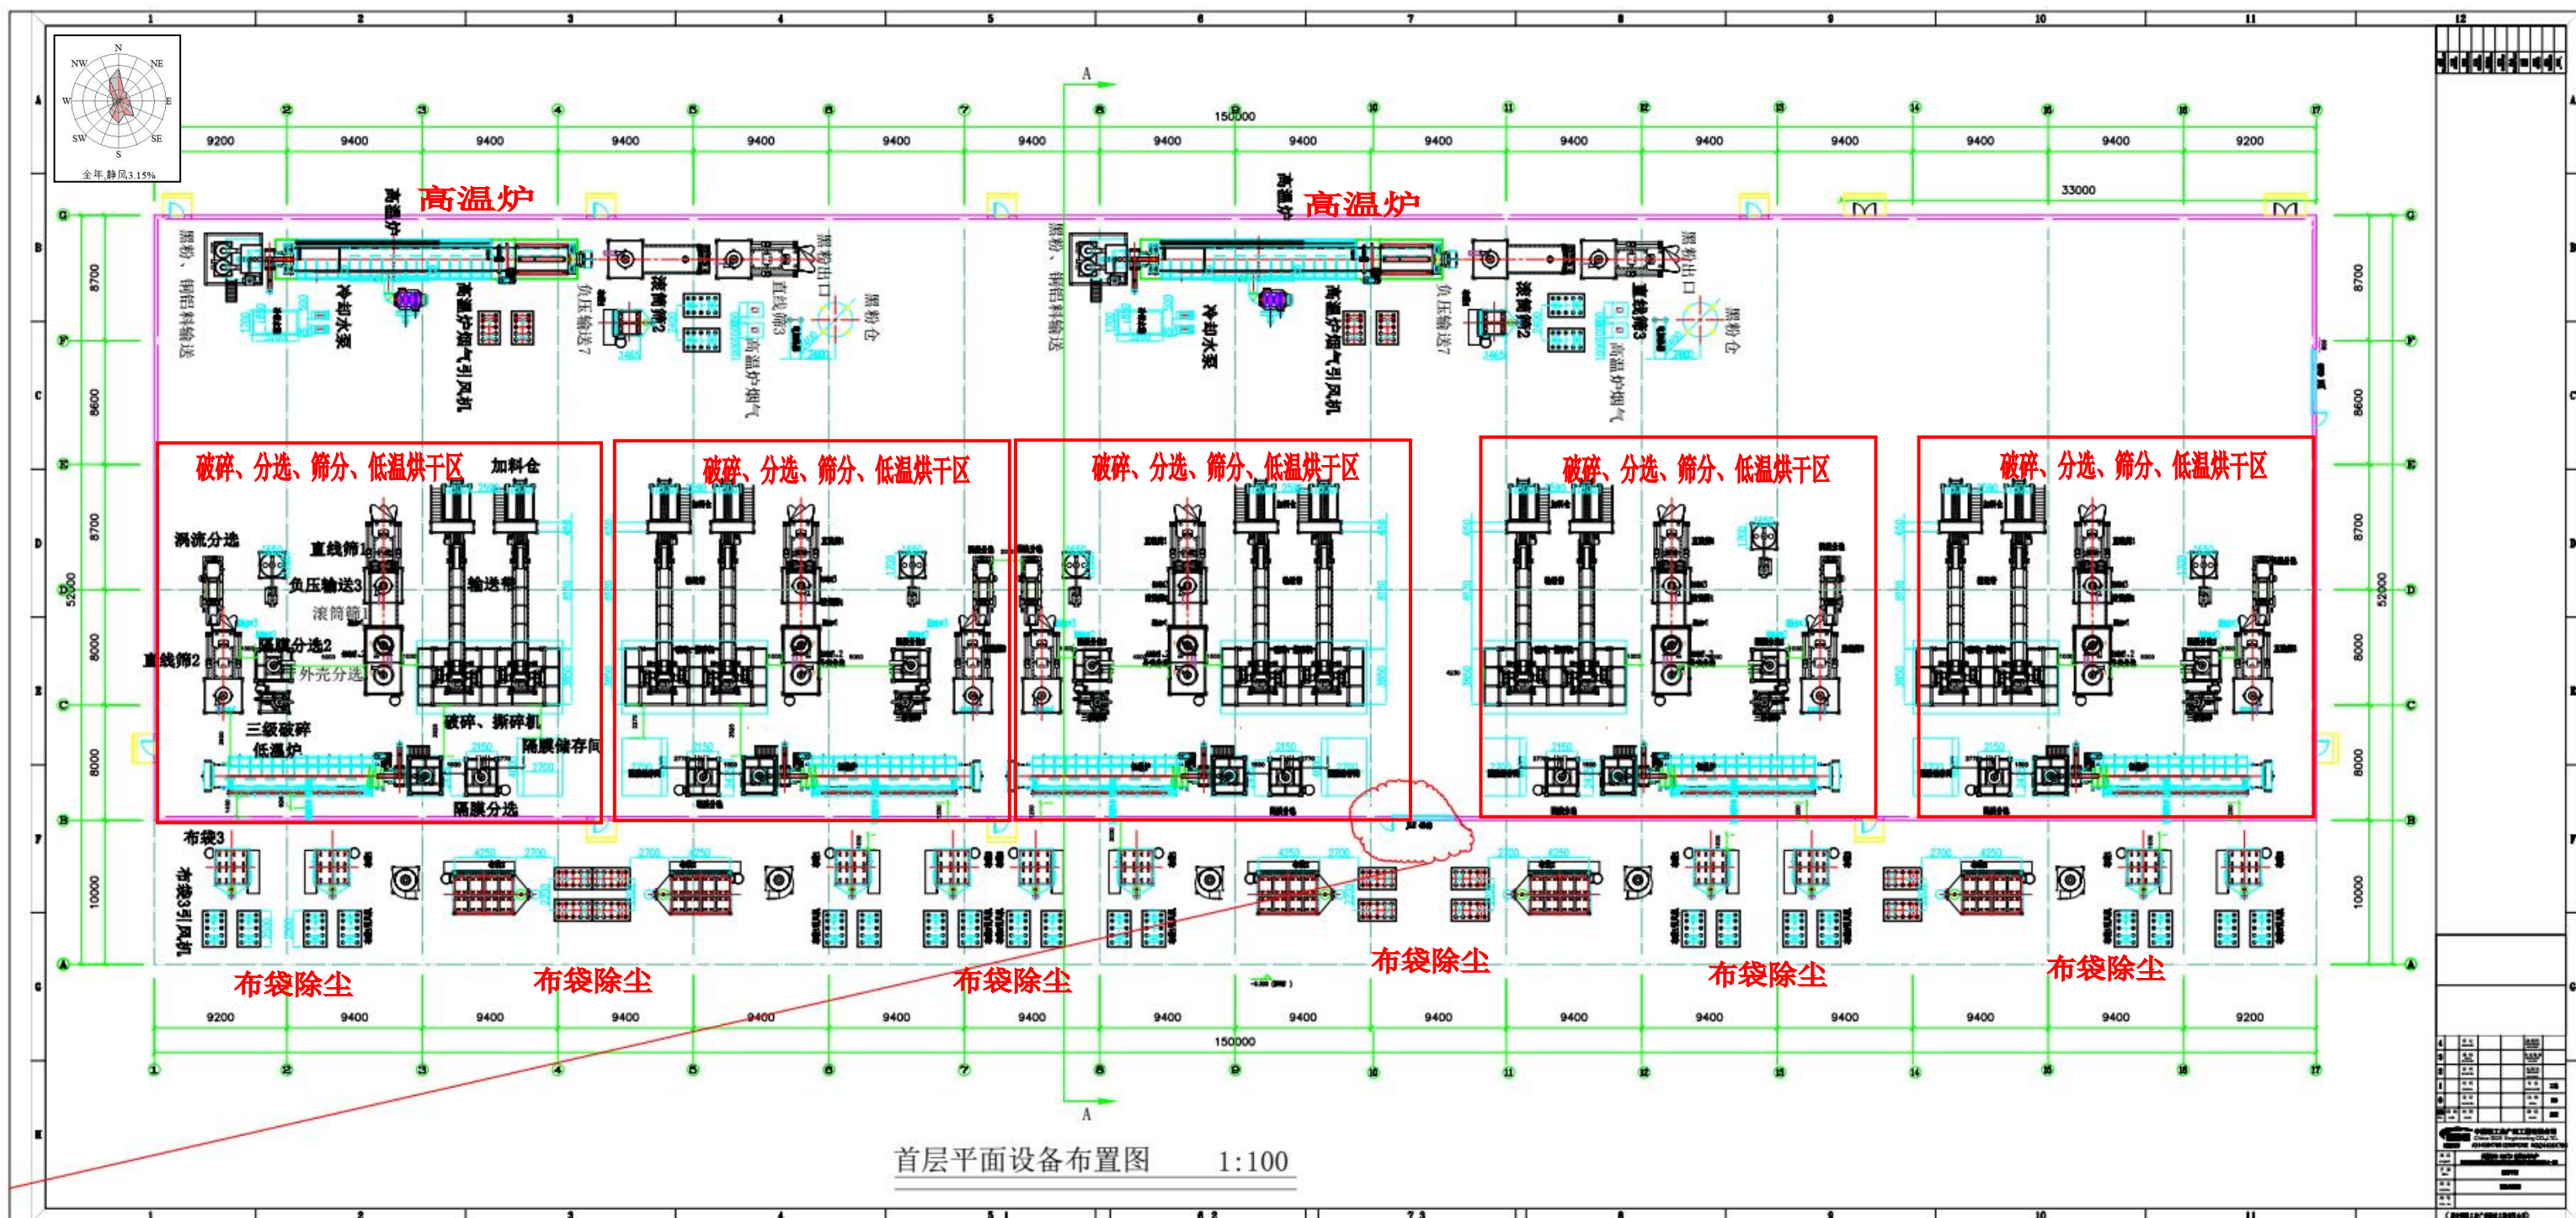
破碎车间（回收利用车间）平面布置图（比例尺1:100）
